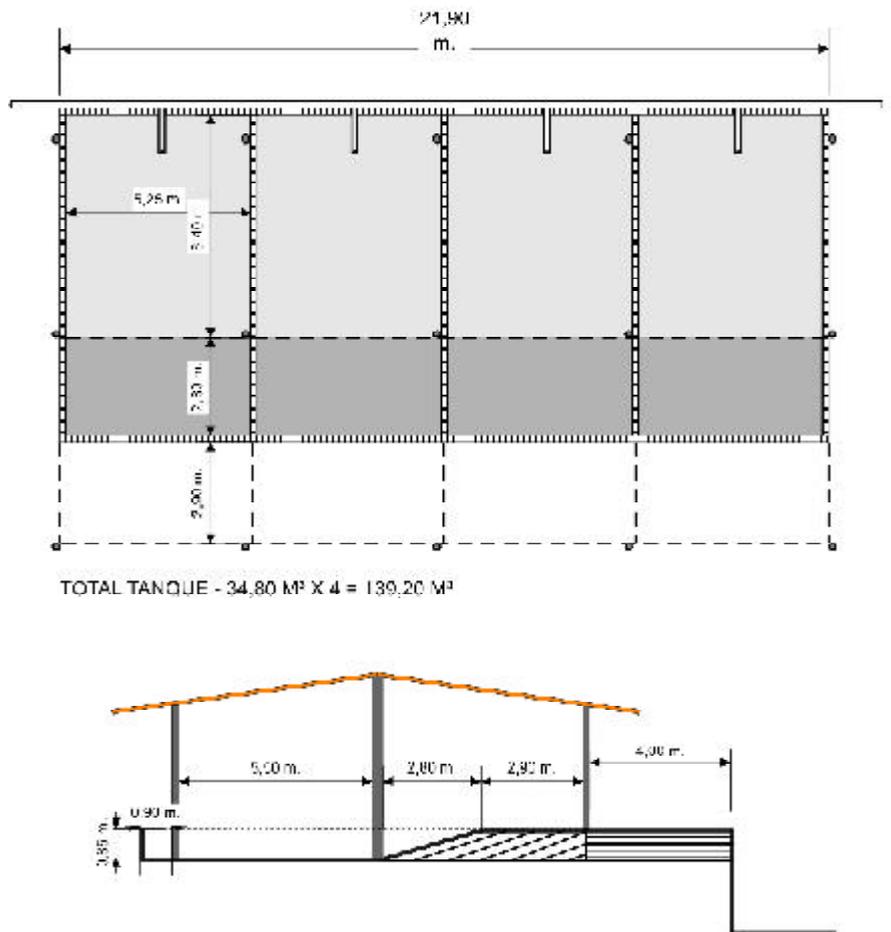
Planta baixa e corte das construções das câmaras de saturação e fermentação sistema mecanizado (Dai Prá, 2003).
